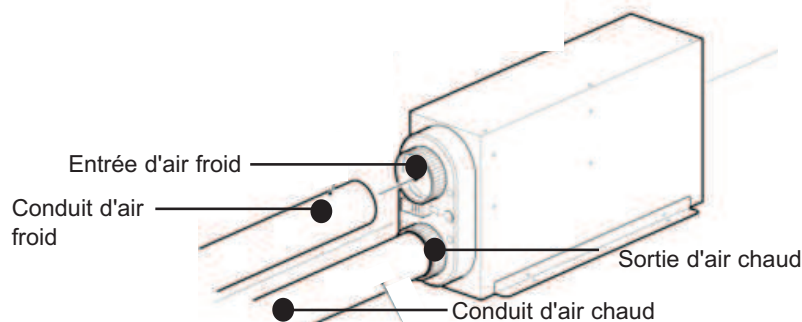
Installation interne - Raccordement au conduit d'air froid
